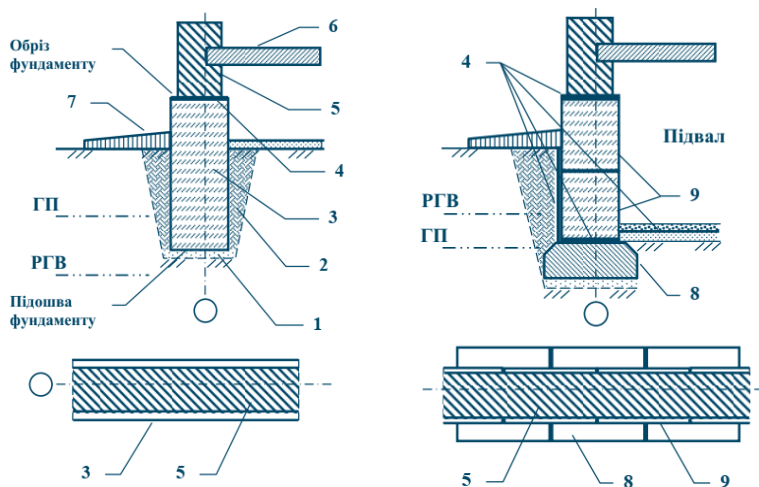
Розрізи стрічкових фундаментів: а) монолітний фундамент; б) збірний фундамент; ГП – глибина промерзання ґрунту; РГВ – рівень ґрунтових вод; 1 – основа; 2 – пазуха; 3 – фундаментна стіна; 4 – гідроізоляція; 5 – стіна; 6 – перекриття; 7 – вимоцнення; 8 – фундаментна плита; 9 – фундаментний блок
